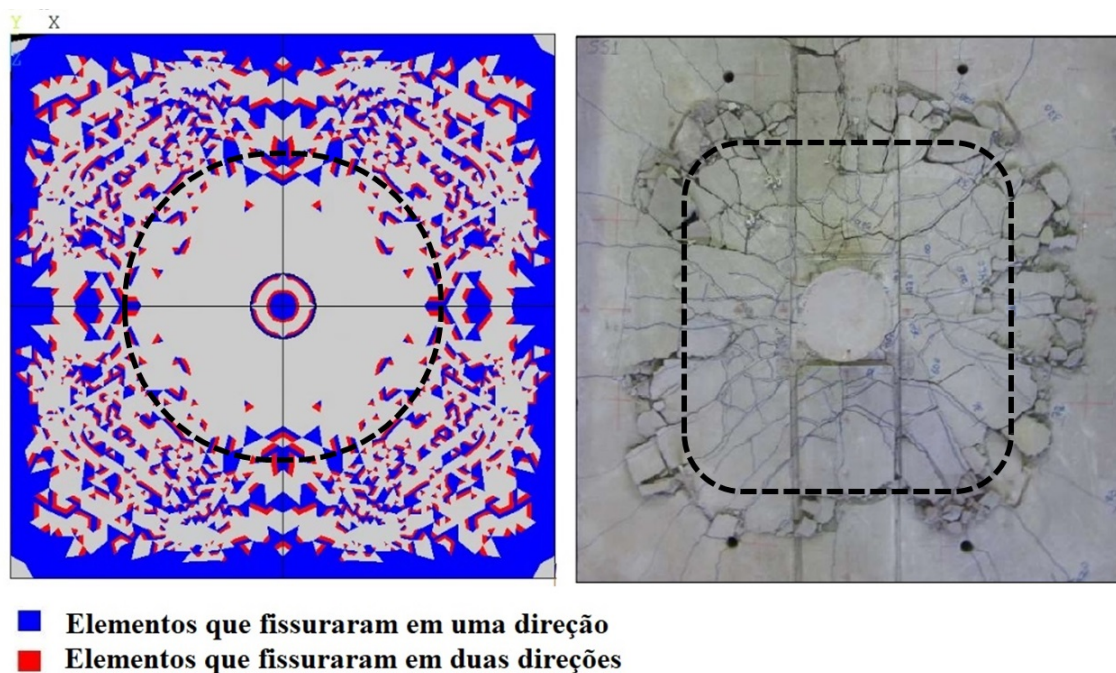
Mapa de fissuração na superfície superior da laje SS1-2 após o ensaio (fonte: Autor)
